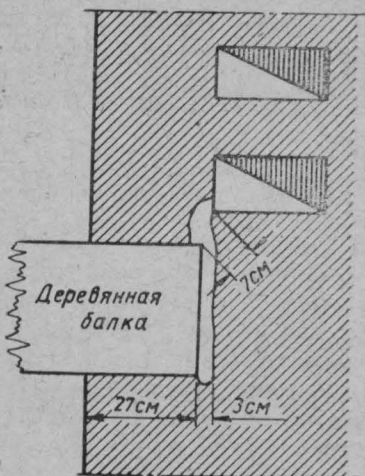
Схема повреждения кладки стены на участке между гнездом балки перекрытия и дымоходом.
